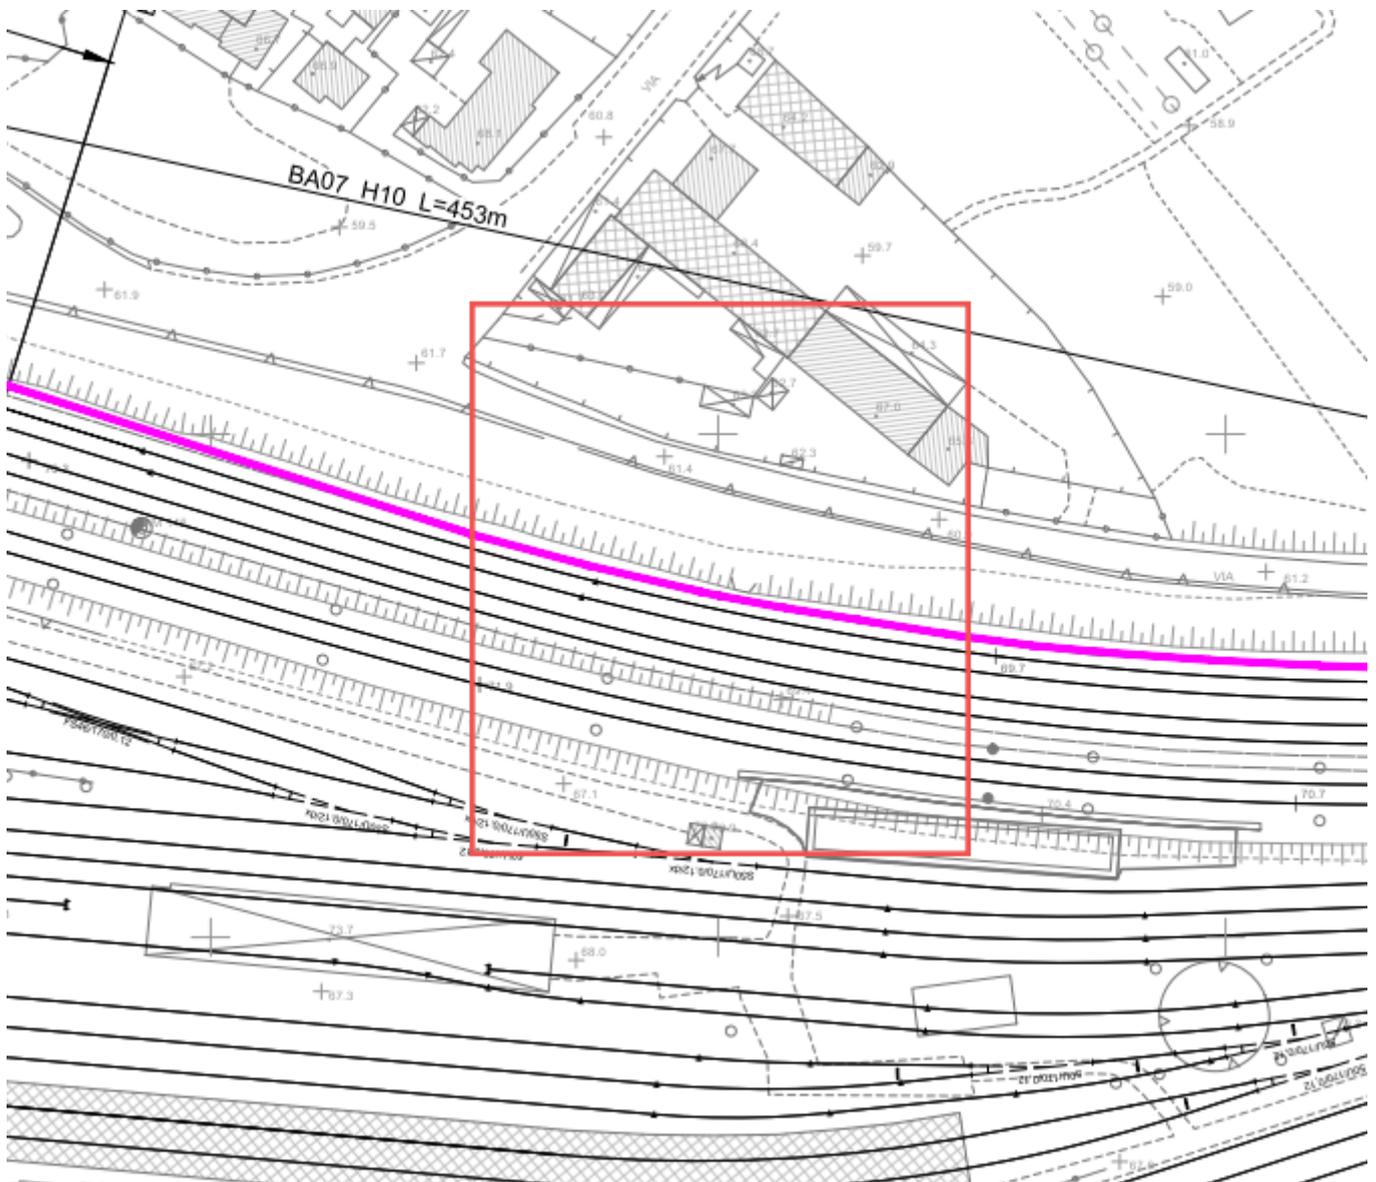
Planimetria di ubicazione dell'opera esistente.
